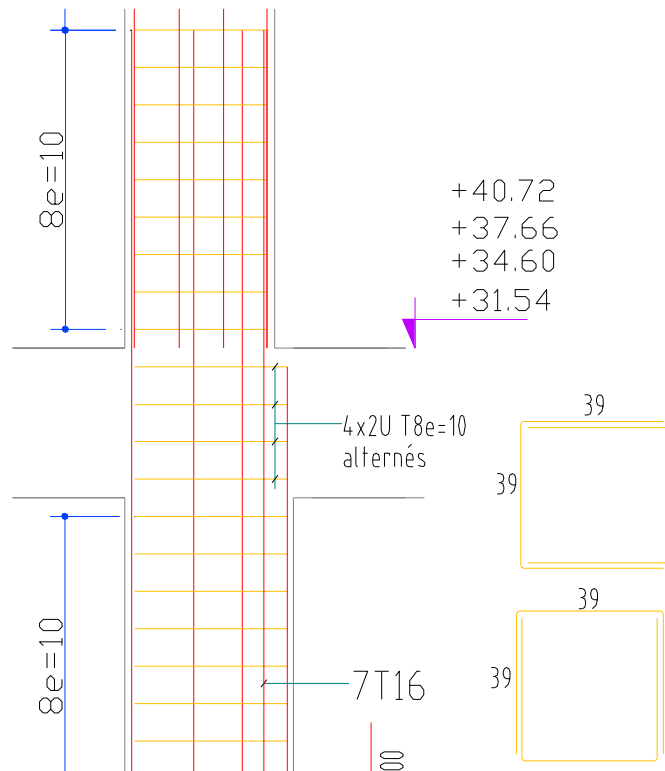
Ferrailage de recouvrement des poteaux $45 \times 45 \text{ cm}^2$ avec les poteaux $40 \times 40 \text{ cm}^2$.
